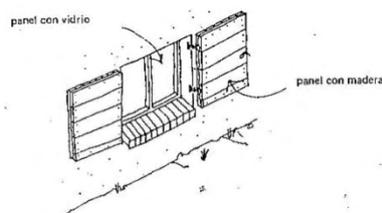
Ventana con protección. Fuente: Van Legen, Johan.(1980). *Cantos del arquitecto descalzo*.
